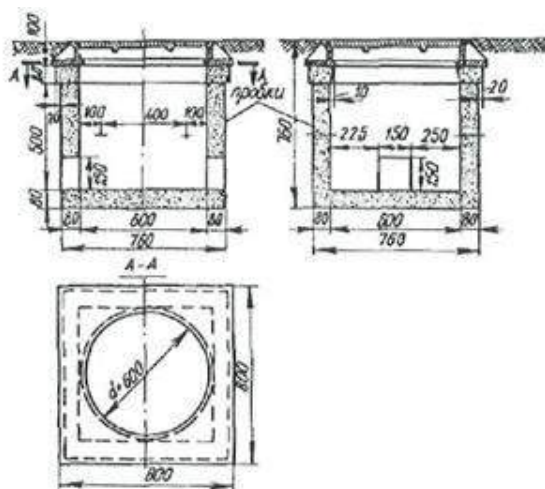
Сборный железобетонный колодец типа ККС-1
